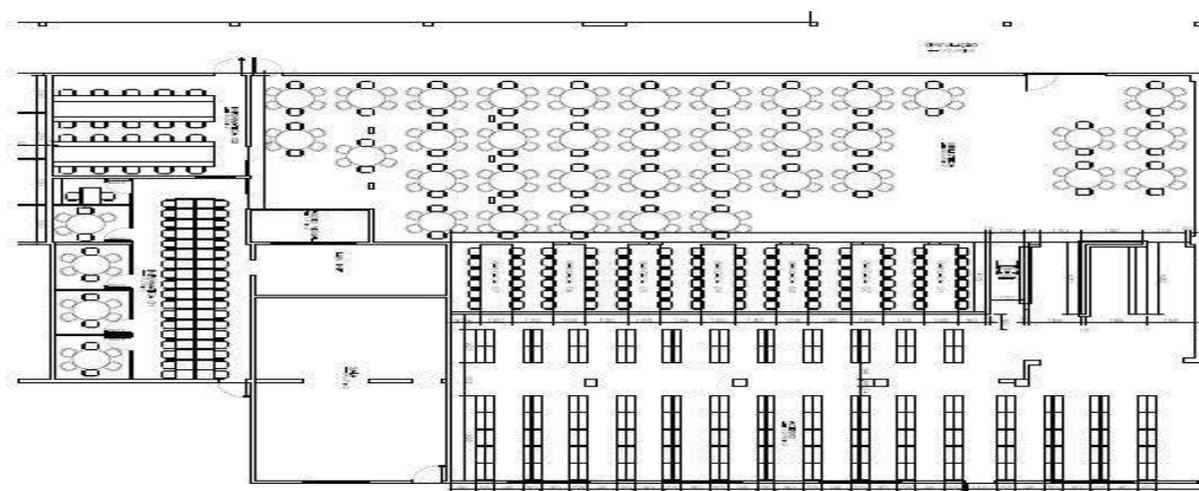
Planta baixa da Biblioteca Central da Faculdade FASIPE.
